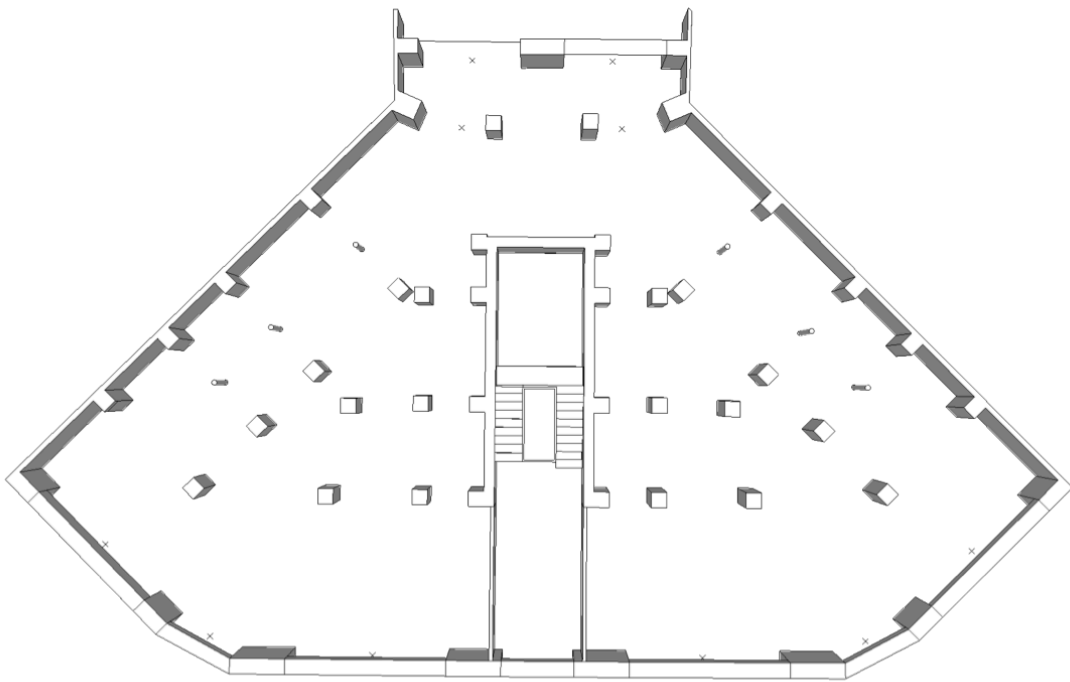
Vista en planta de PLANTA BAJA del edificio ED-04 (fuente: elaborado por el autor)
